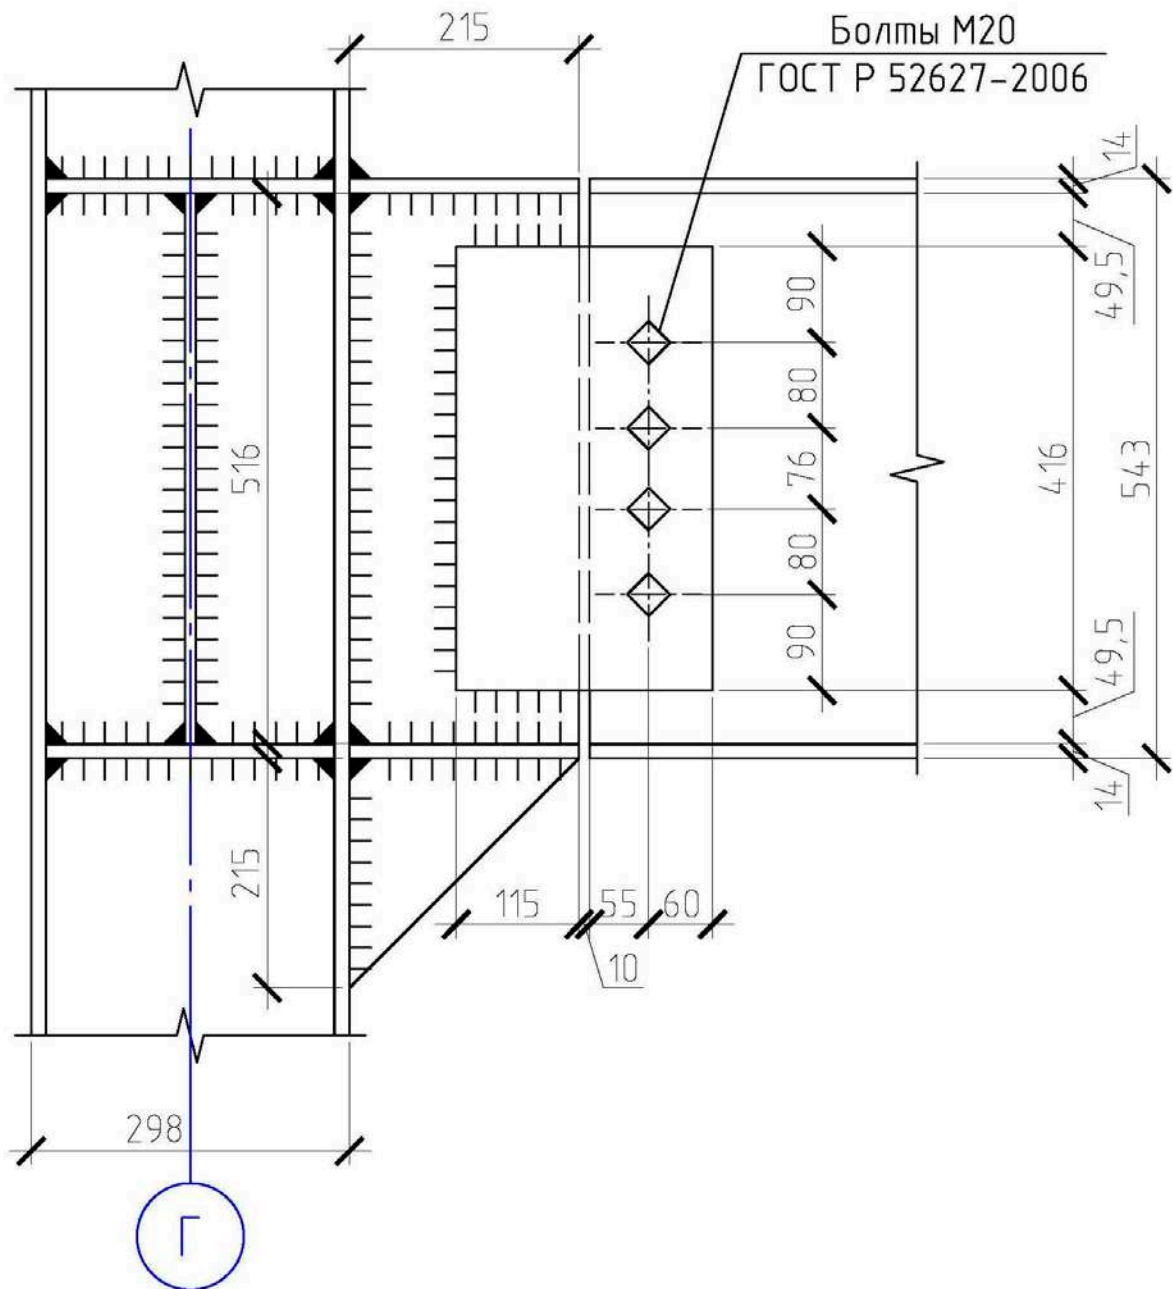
Узел сопряжения колонны с балкой перекрытия
